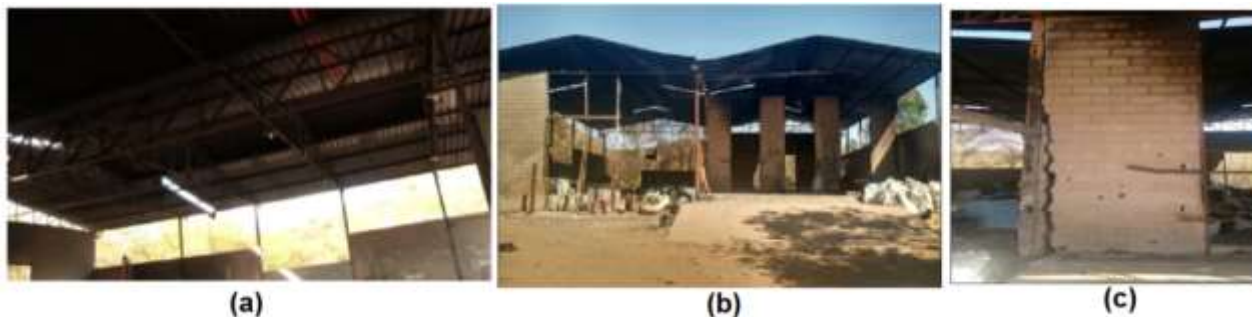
(a) estrutura do telhado afetado pelas chamas, a área do telhado possui bastante fuligem em boa parte da área interna, (b) entrada do galpão e (c) trinca da alvenaria após o incêndio. – Fonte: o autor, 2017.
